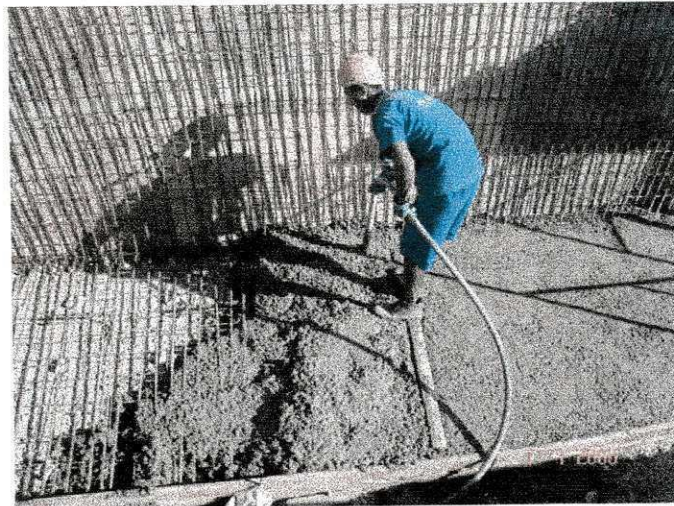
adensamento do concreto através da utilização de vibrador de imersão
